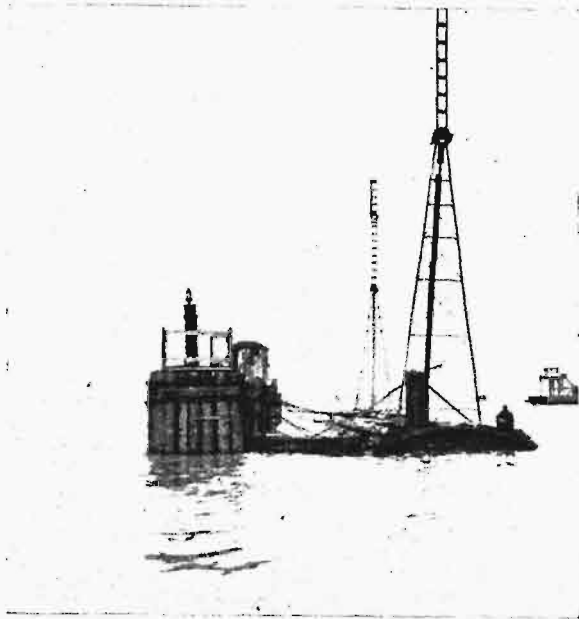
Miejsce betonowania wewnętrznych i zewnętrznych powłok sekcji.
